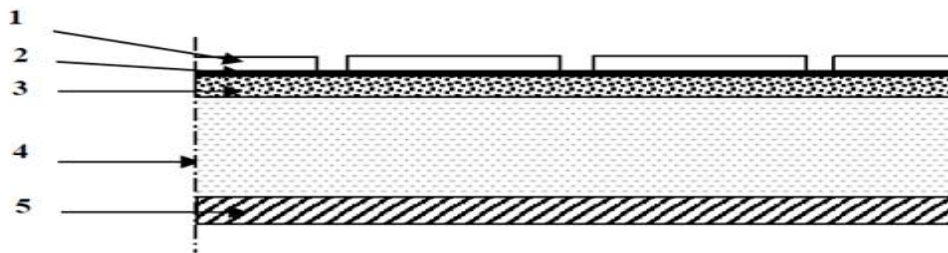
Coupe vertical du plancher courant à dalle pleine.
